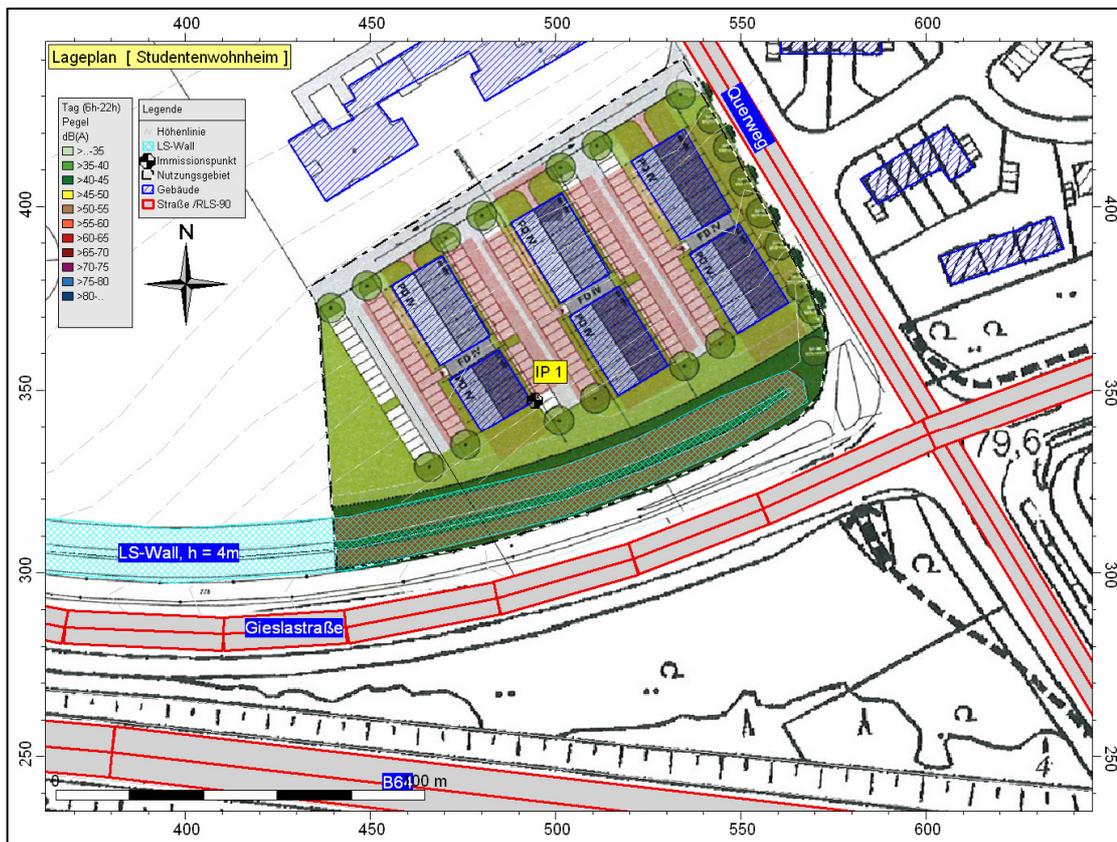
Lageplan Ausschnitt Studentenwohnheim
